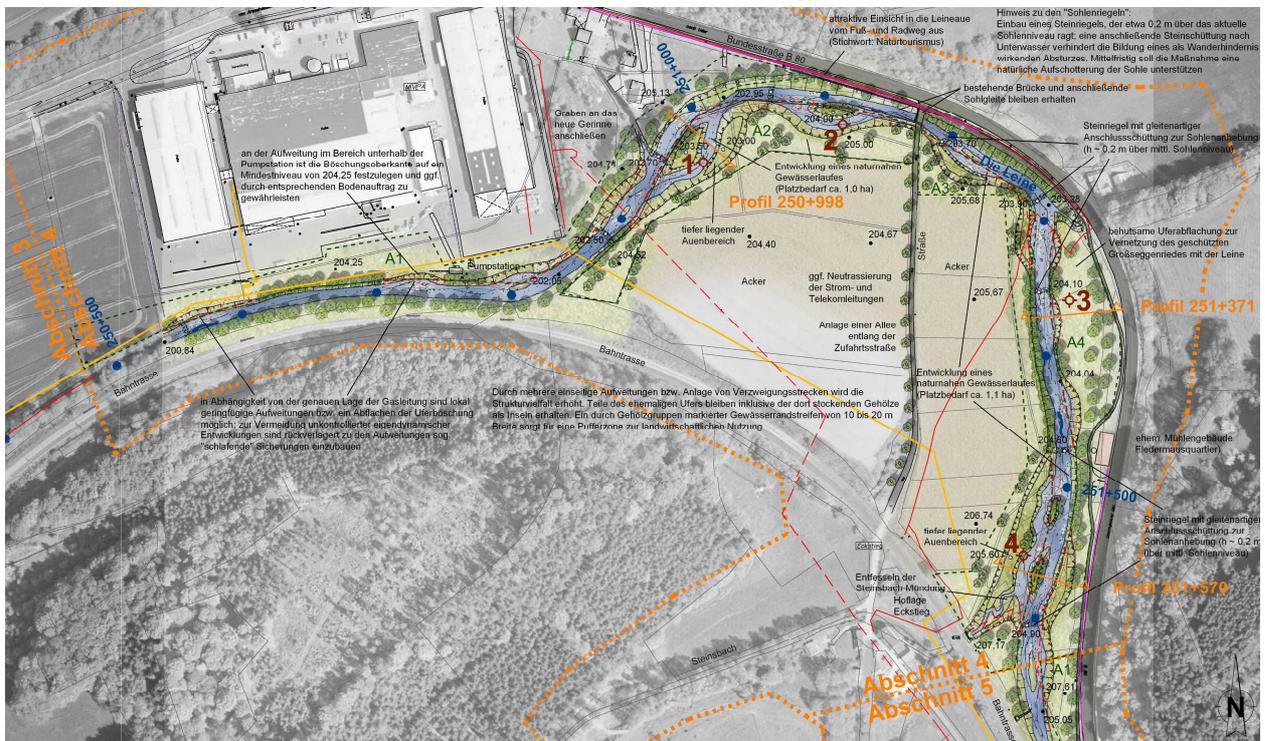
Maßnahmenabschnitt 4 in der Planung (vgl. Plan B-3.04)
